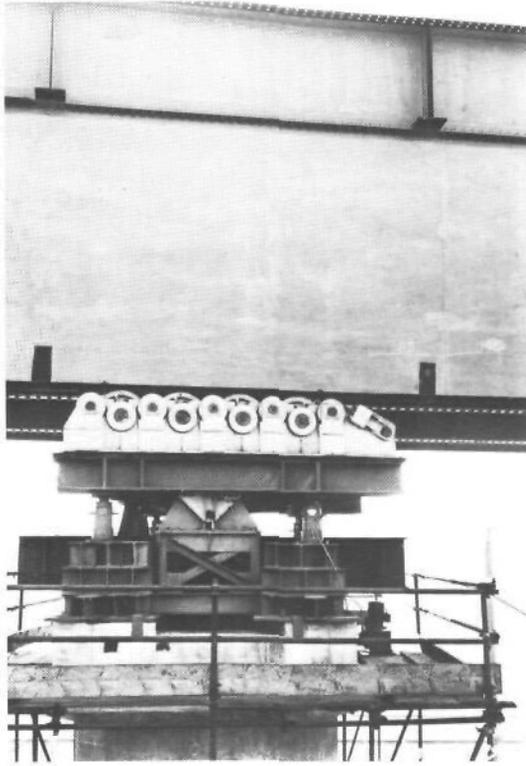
Chaise à câbles montée sur plateau support. Le plateau est muni d'un pivot central et repose sur des vérins connectés.
